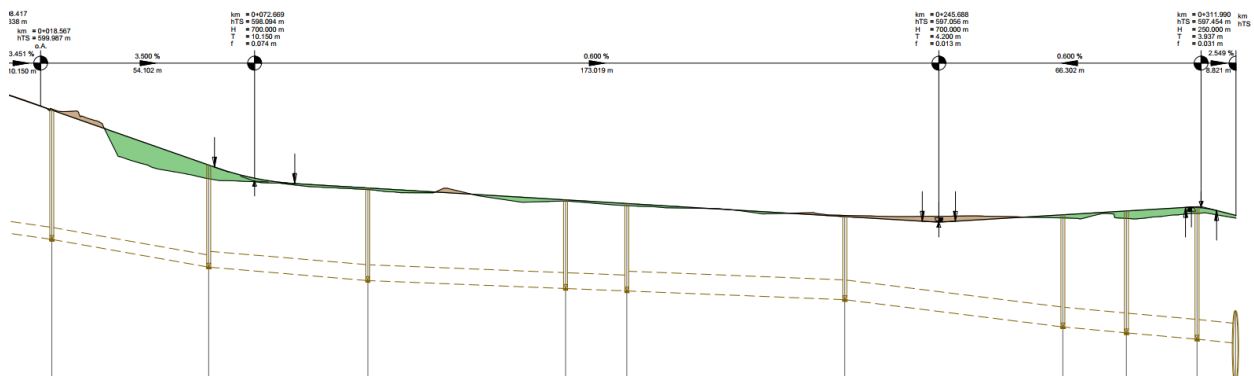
Höhenplan Straßenplanung Güterhallenstraße, Stand 05.06.2023, Ingenieurbüro BPR, Traunstein
